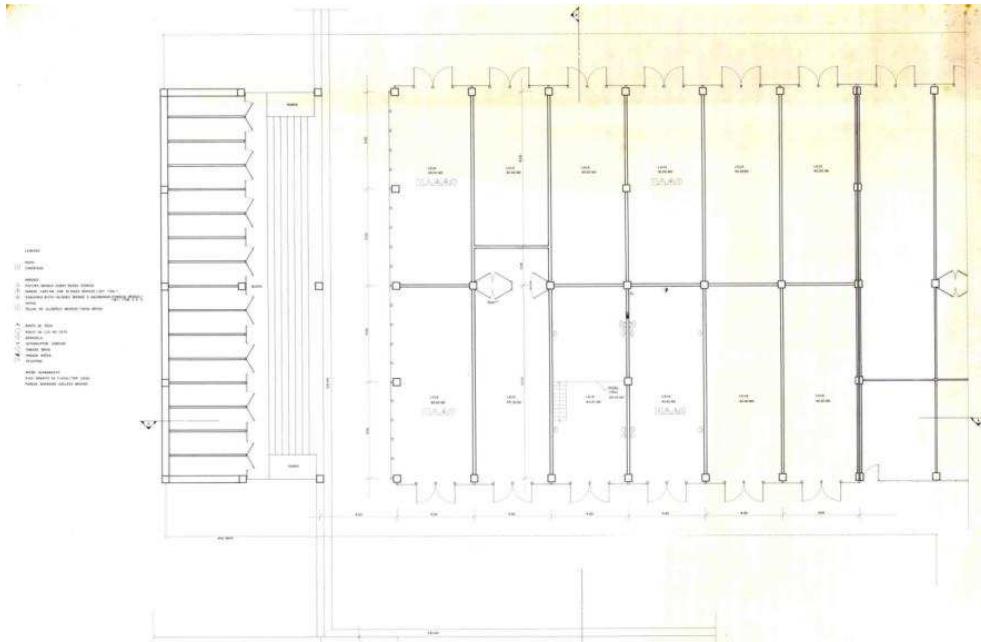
5º Estudo, Planta baixa (Desenhos de Amaro Machado, Arquivo do NPD)
